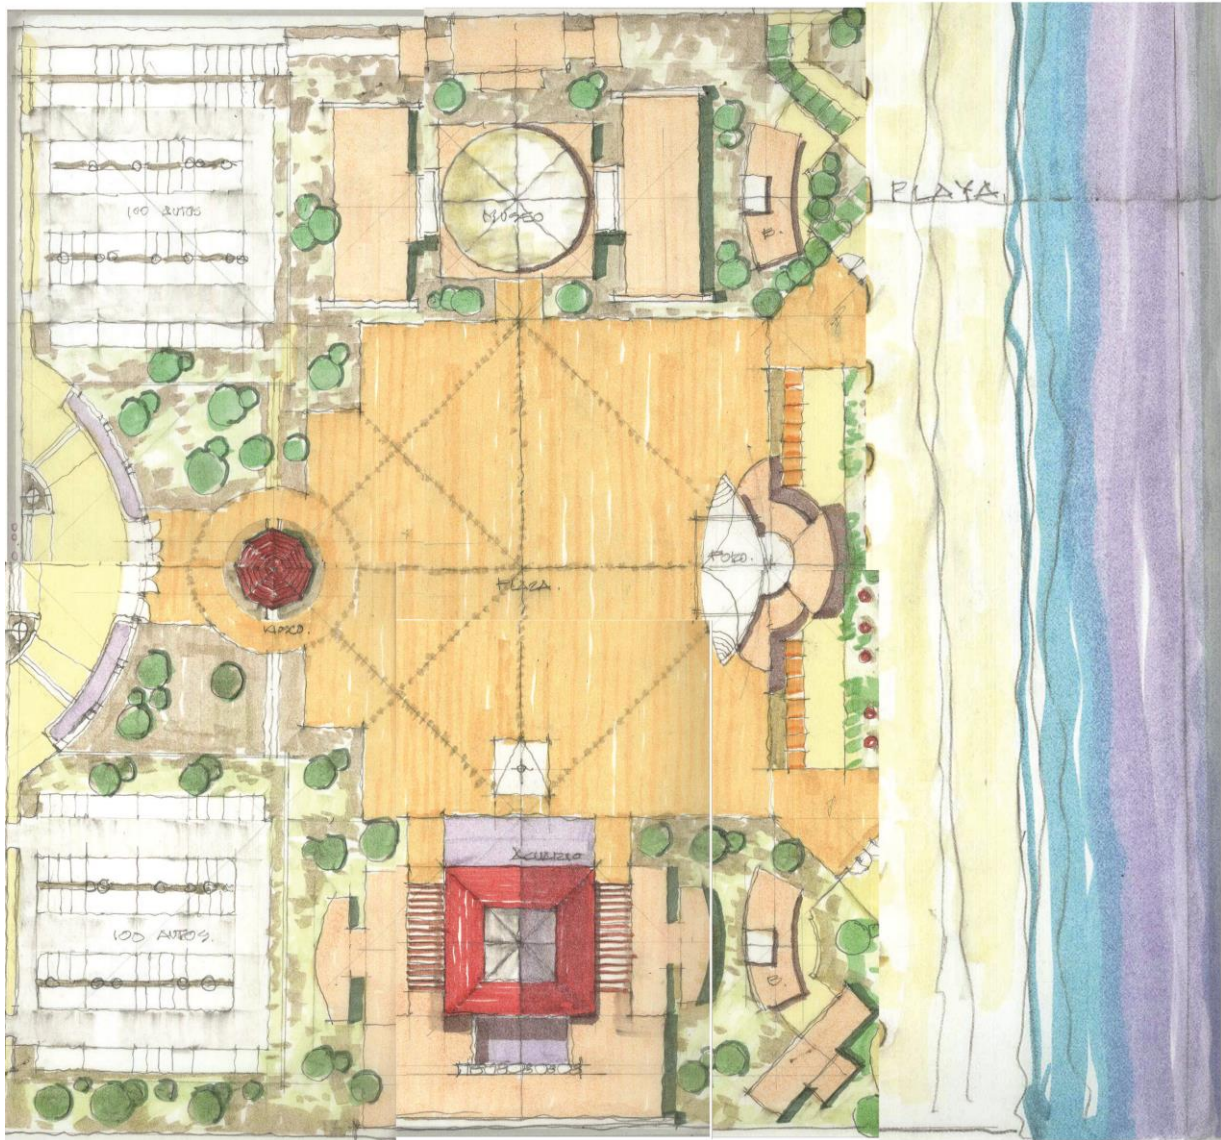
Concepto en Planta Arquitectónica y Distribución. Autor: Arq. Arturo Cuevas
